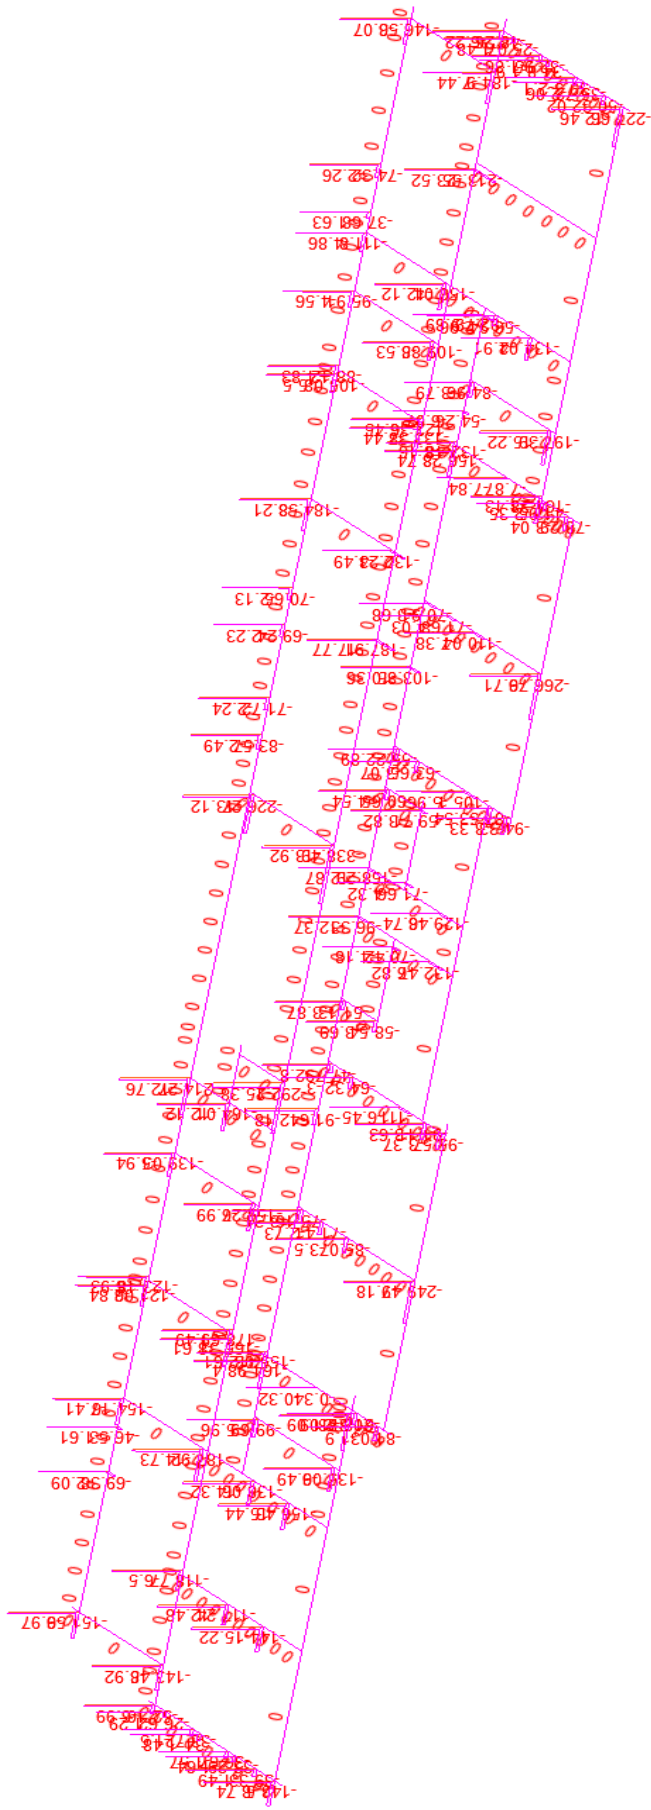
Эпюры продольных усилий N (в Т) в элементах железобетонного ленточного фундамента и сердечниках
